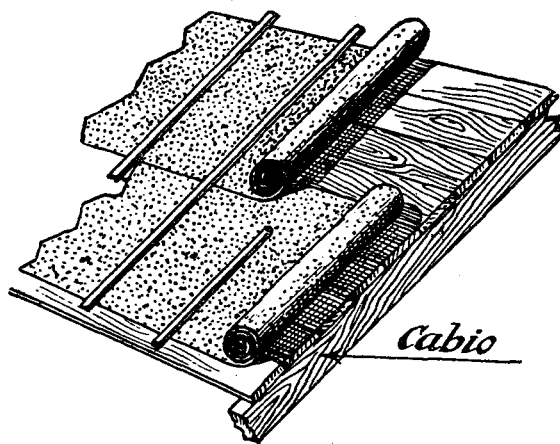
Cubierta de cartón embetunado, con las tiras dispuestas paralelamente a la cumbrera.
